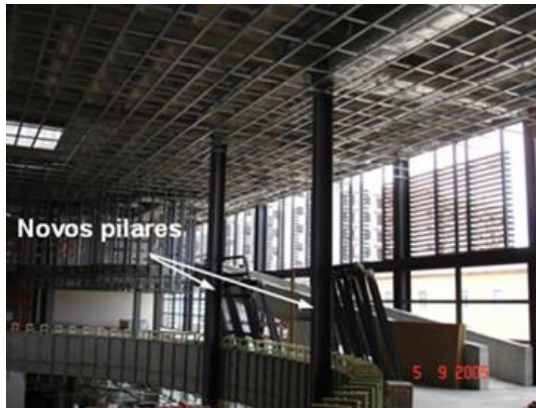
Reforço por alteração do sistema estrutural com a colocação de novos pilares metálicos (23).
